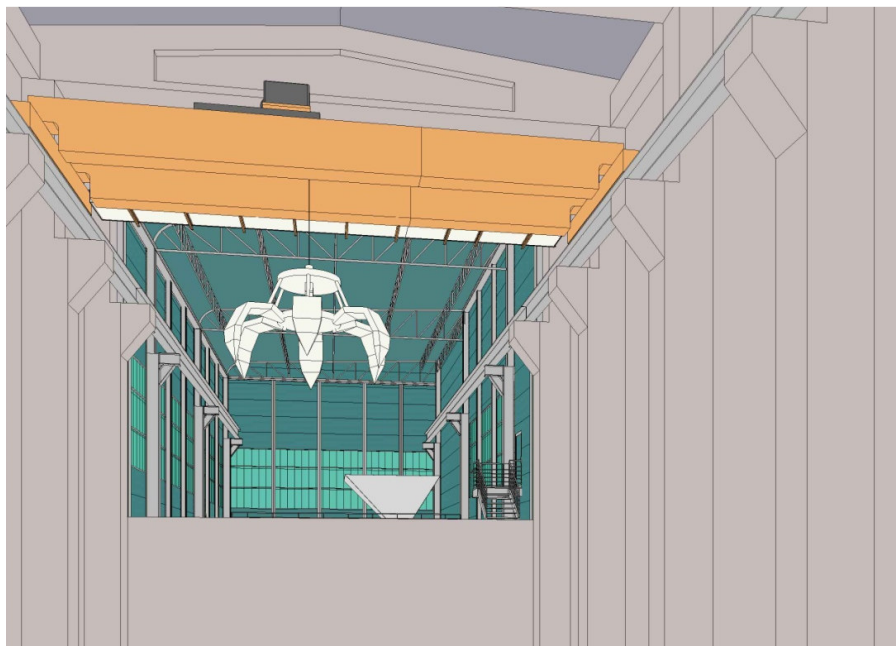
Edificio Fossa: apertura parziale del tamponamento per il passaggio del carro ponte – stato di progetto
